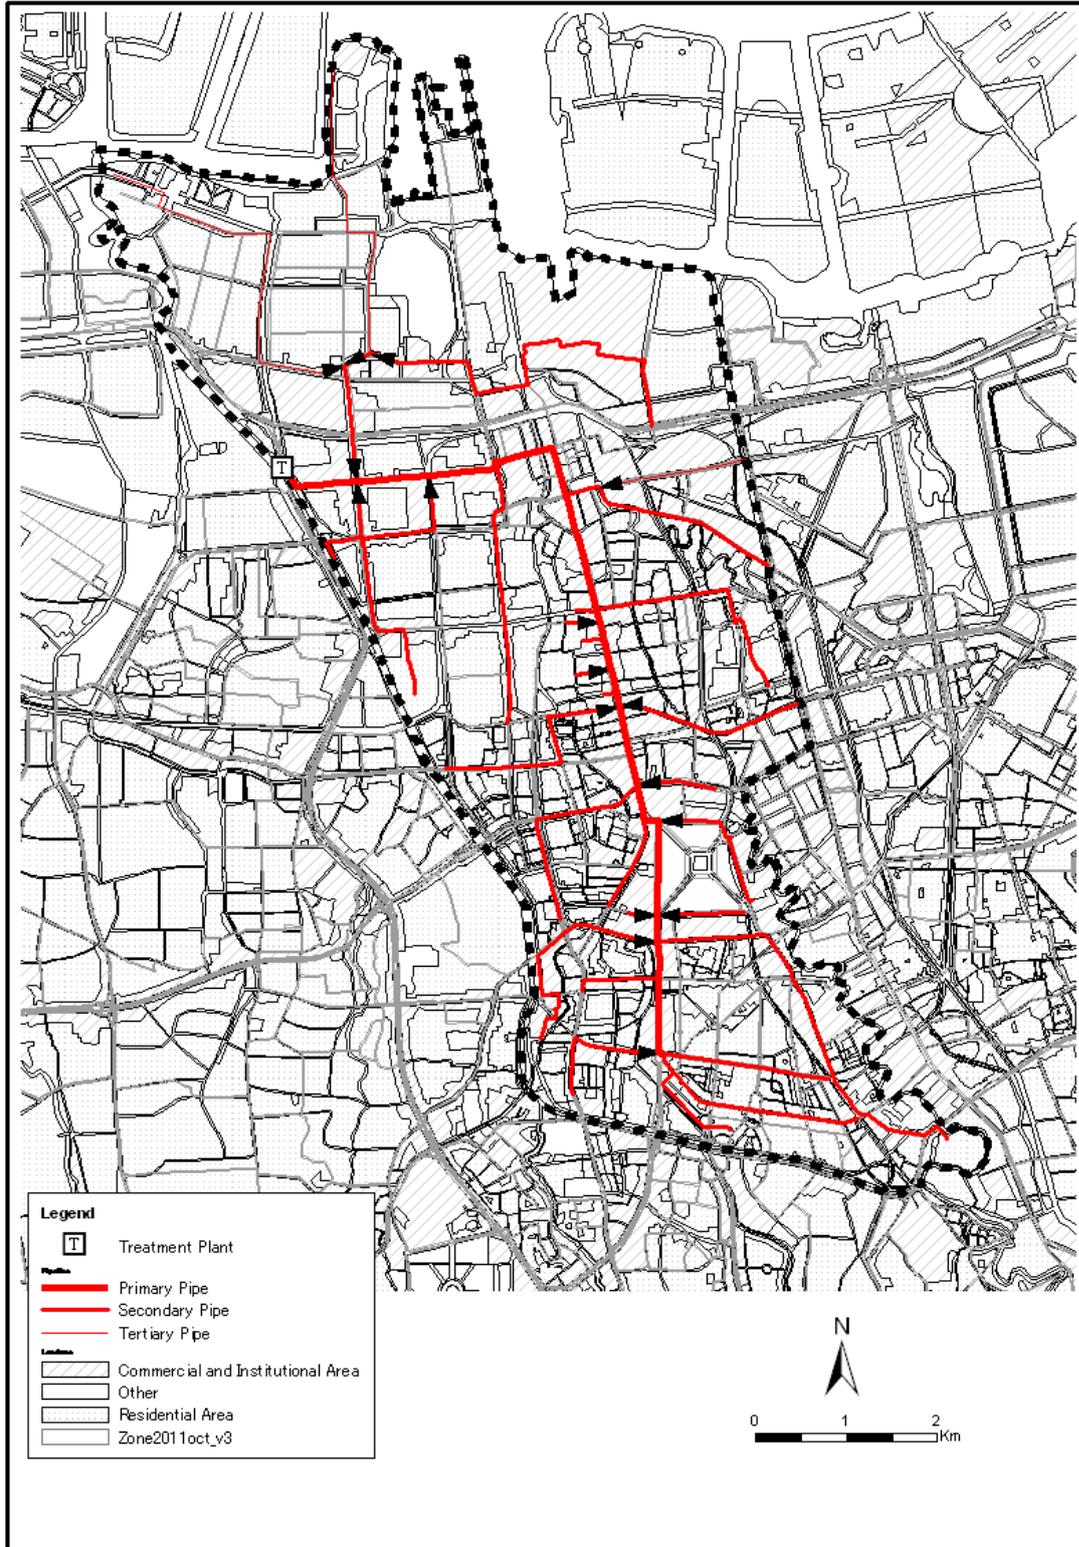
Rencana Layout untuk Fasilitas Sewerage Utama pada Setiap Zona Sewerage
